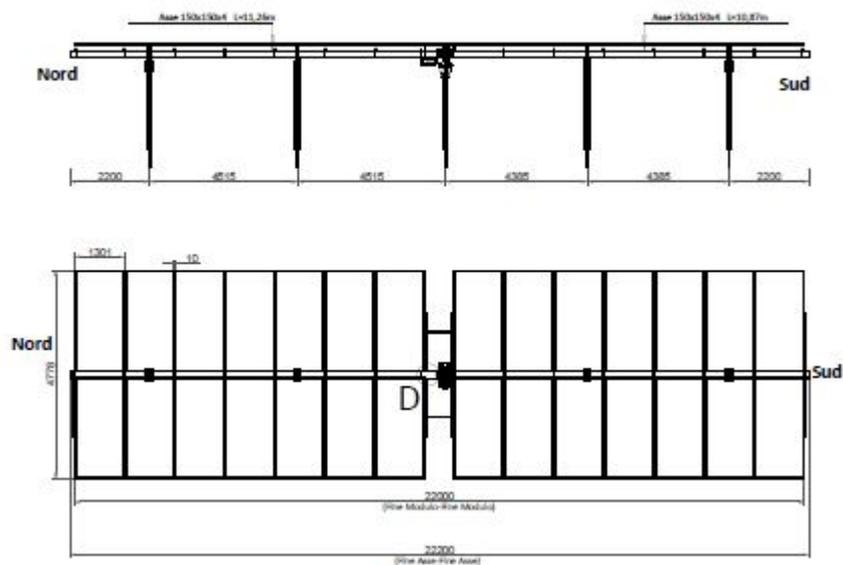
Particolare vista in sezione e in planimetria delle strutture monostringa (14 pannelli)
